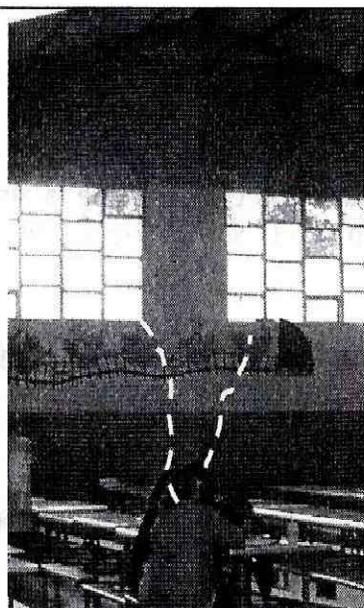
Se observa la parte interna del muro donde se identifica las grietas.
